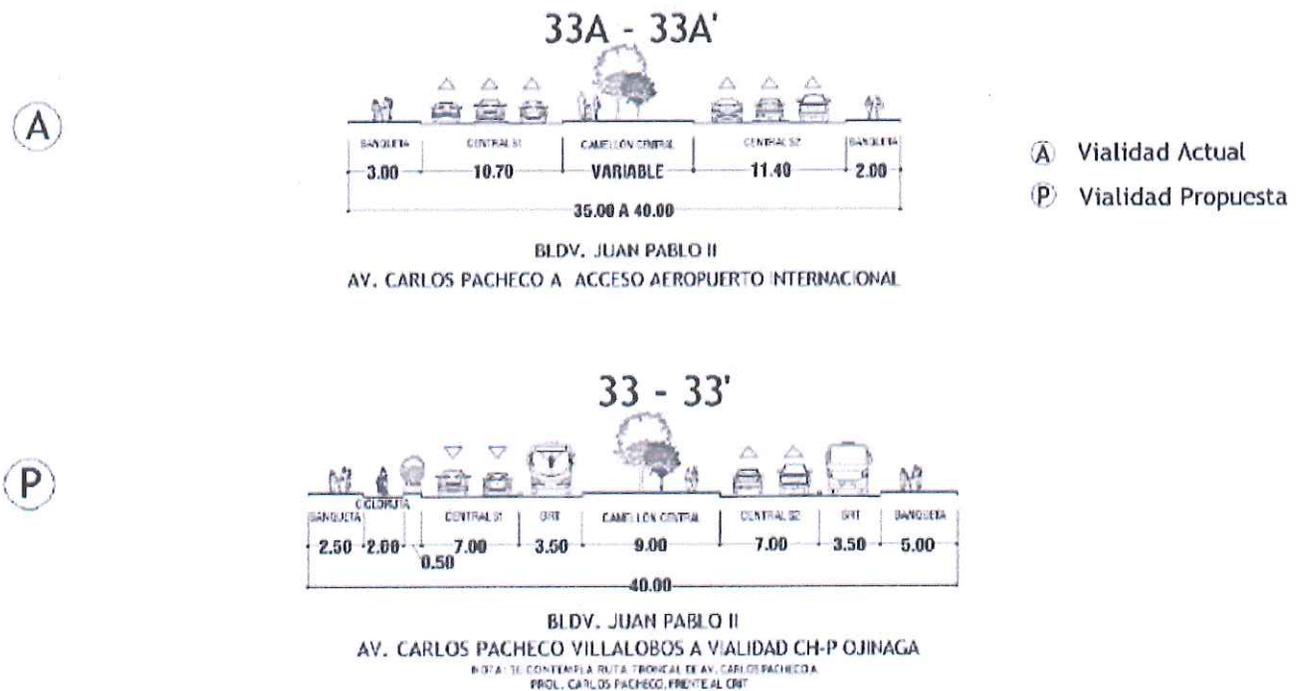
Sección vial actual y propuesta para Avenida Blvd. Juan Pablo II. Fuente PDU 2040.
